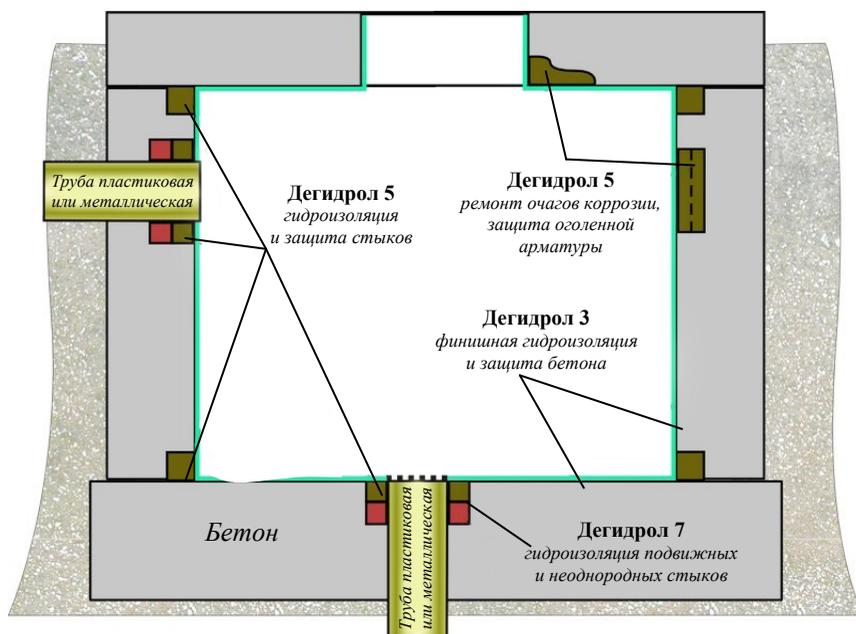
Типовая схема гидроизоляции бетонного сооружения
